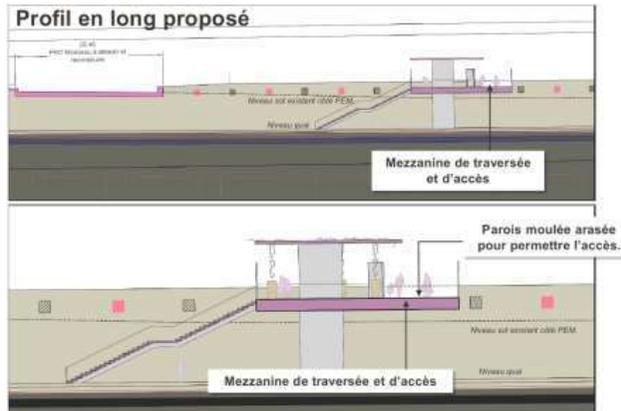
Profil en long de la halte d'Arenal (AREP, 2021)
